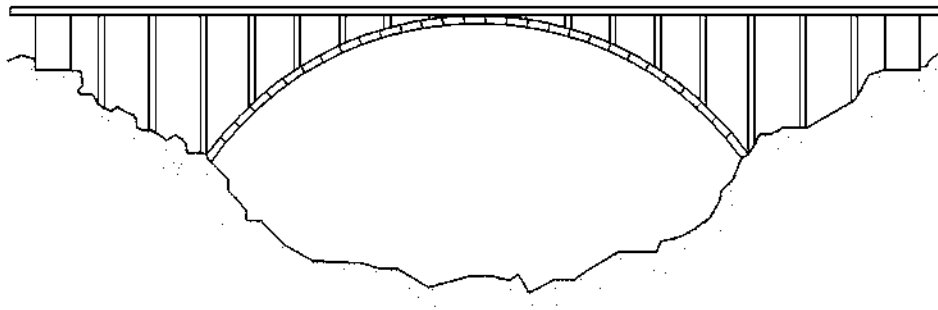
i Construcción de últimas pilas y terminación del tablero.
